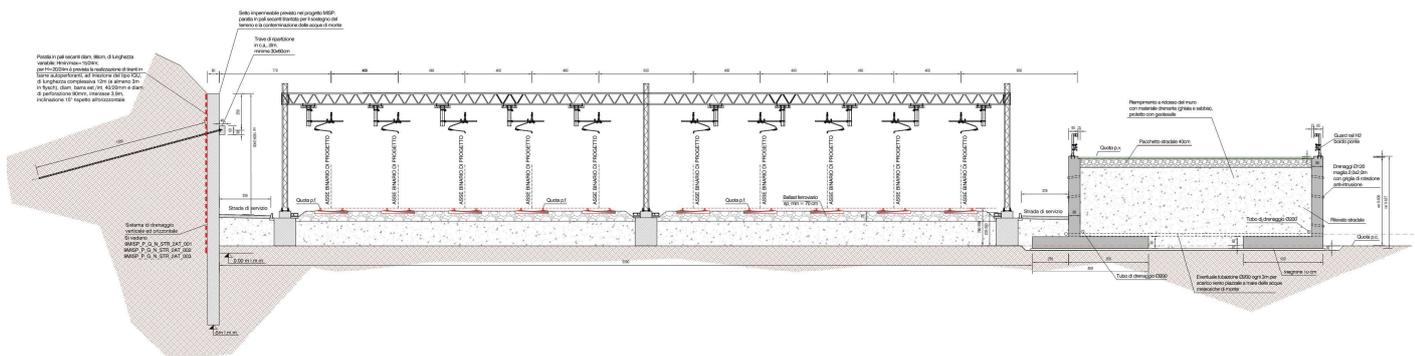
sezione tipo del rilevato ferroviario in corrispondenza della collina di Servola (sulla sinistra nell'immagine) e del vicino rilevato stradale tratta dal progetto delle strutture ferroviarie del PFT AdSPMAO n. 1951; sotto al rilevato stradale e a destra del muro a L visibile a destra nell'immagine è continuo il telo del capping delle MISP; il volume che si rende disponibile con lo scavo del piede della collina di Servola contribuisce al riempimento dei rilevati ferroviario e stradale anche esterni al perimetro della MISP
